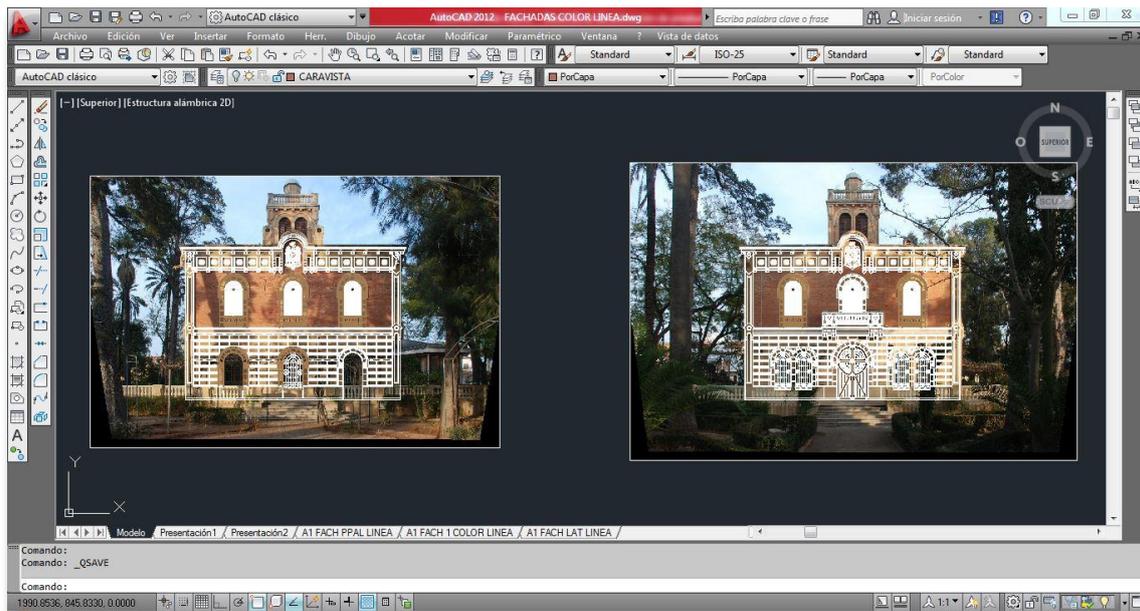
Proceso de levantamiento de las fachadas en AutoCAD. 2015. Fuente propia.
